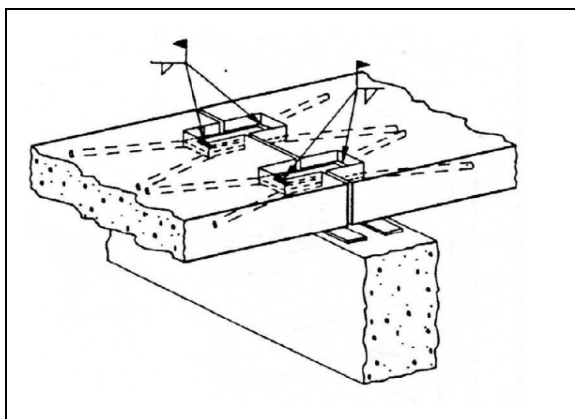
Ligação de lajes através de chapas soldadas, assentes em neoprene, em paralelo com a laje (PCI)
